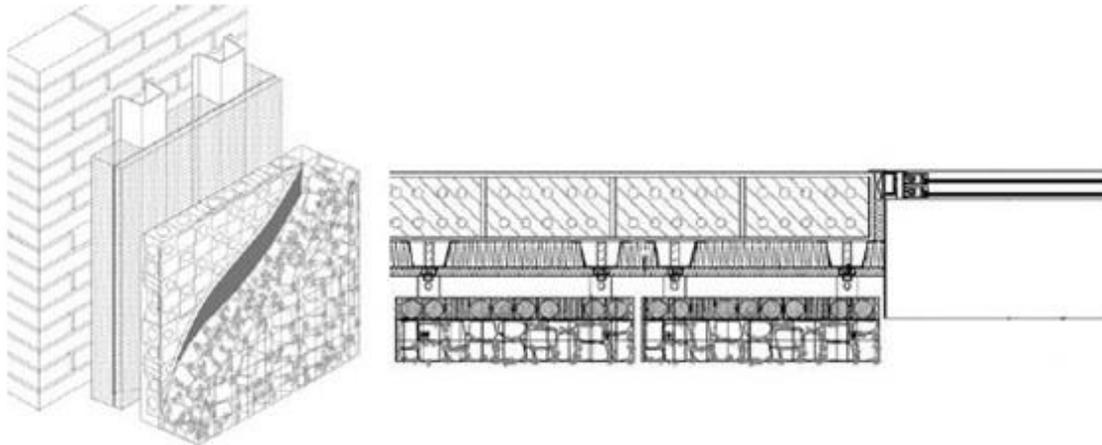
Fachada verde con sistema de gaviones metálicos.
